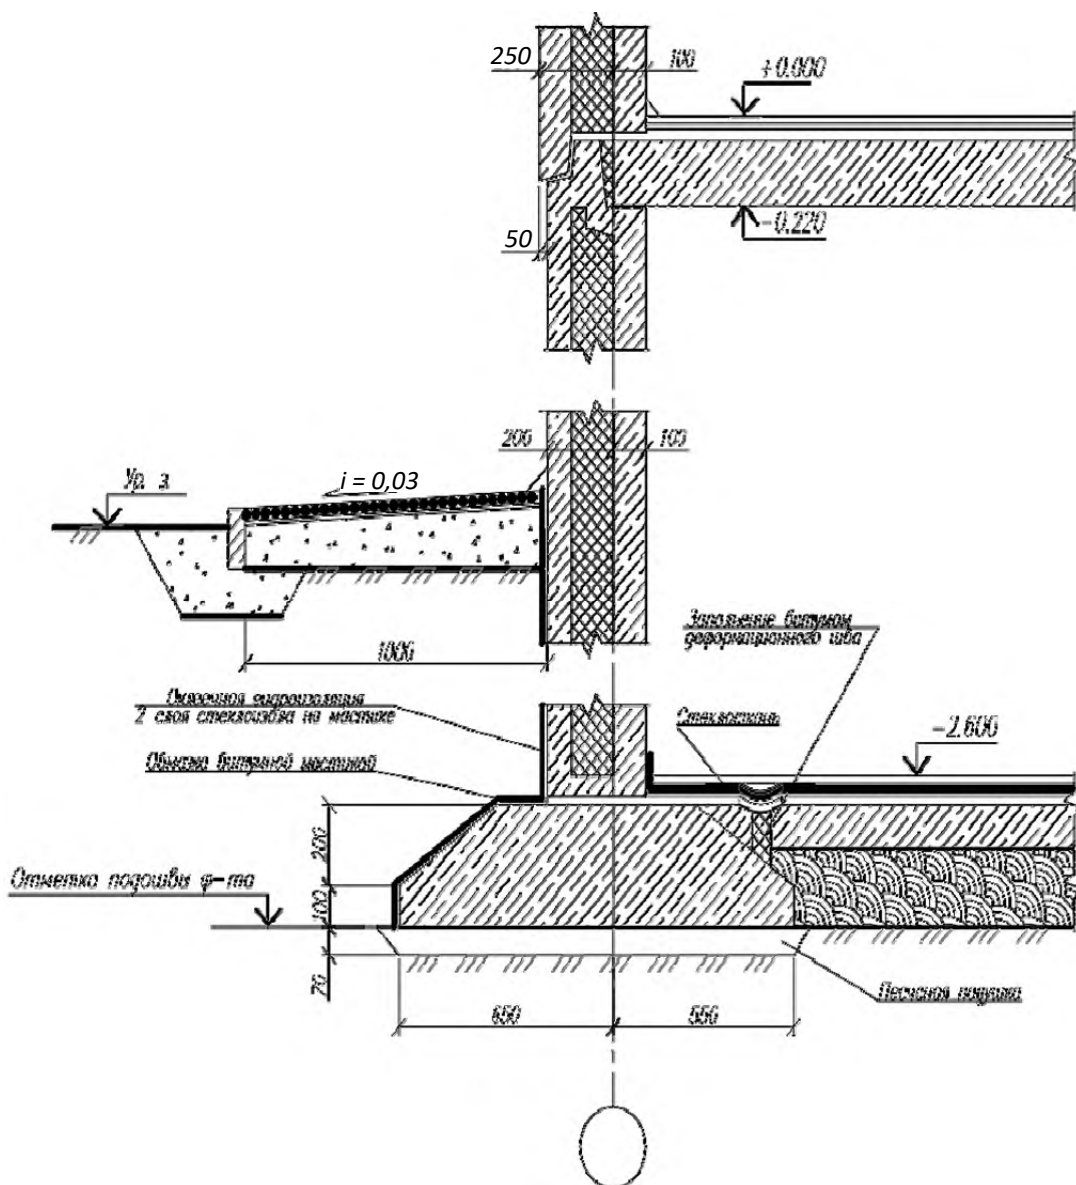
Узел сборного железобетонного ленточного фундамента
